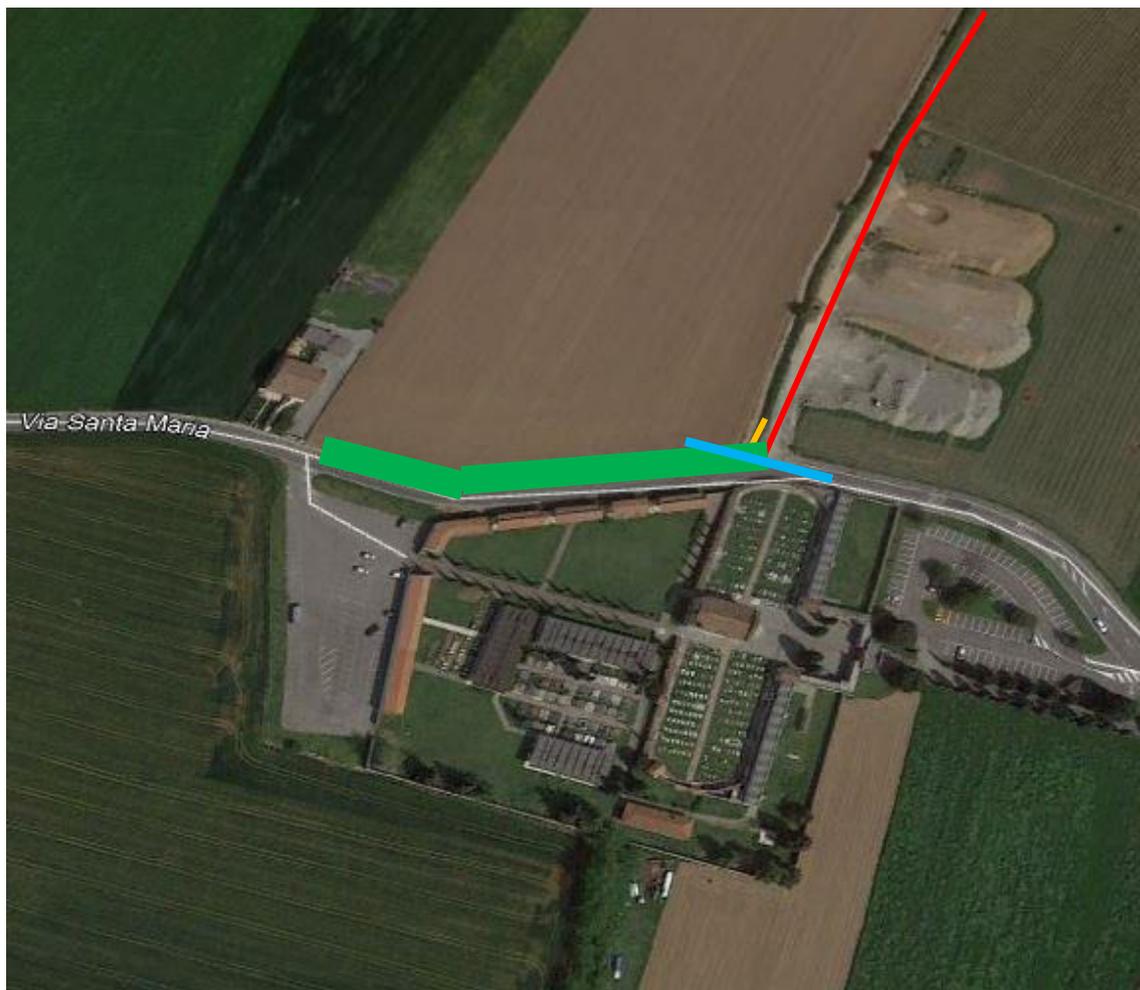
rappresentazione schematica intervento di mitigazione del rischio idraulico:
